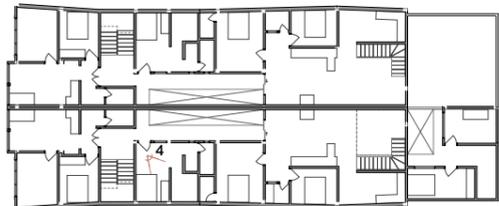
Planta baja y primera planta alta del inmueble seleccionado
